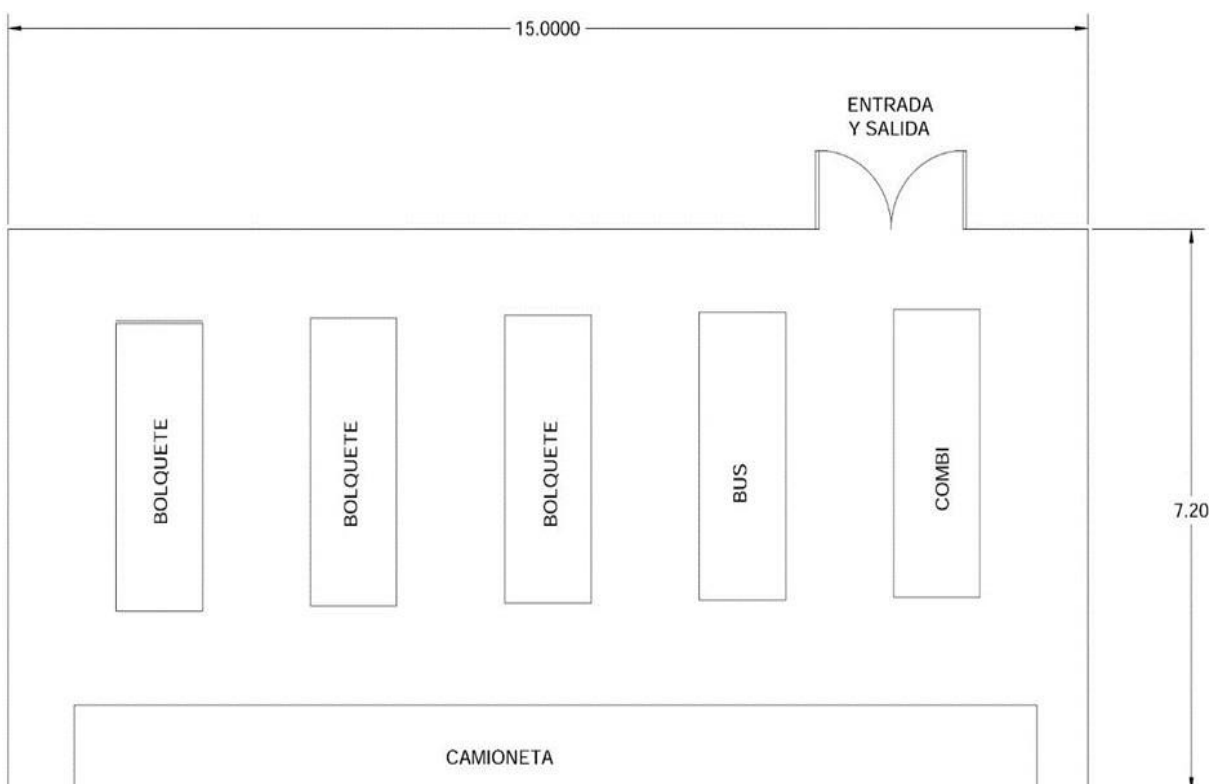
Métodos a utilizar en el plan de mejora – Layout para área de llantas
